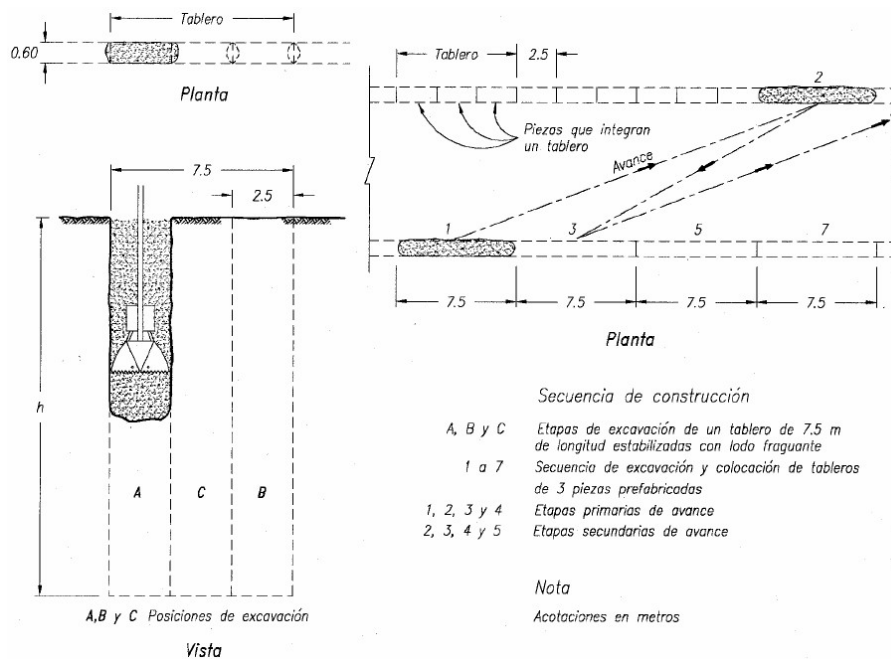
MURO PREFABRICADO CON AVANCE MODULAR
